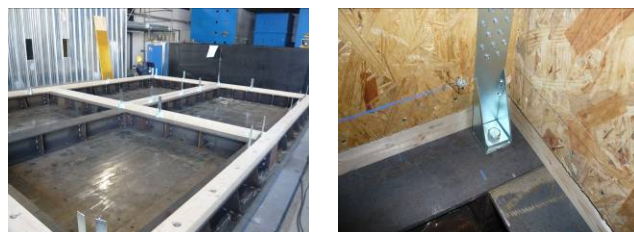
Graticcio di travi in acciaio e collegamento con le pareti strutturali
